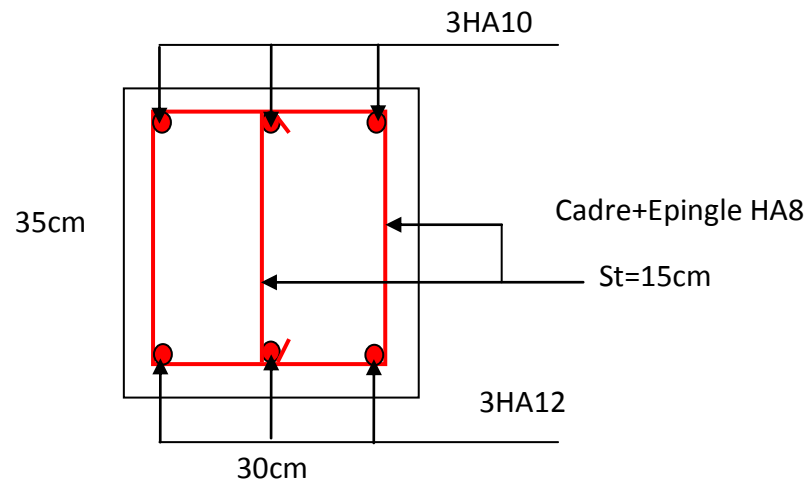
Schéma de ferrailage de la poutre de chaînage
